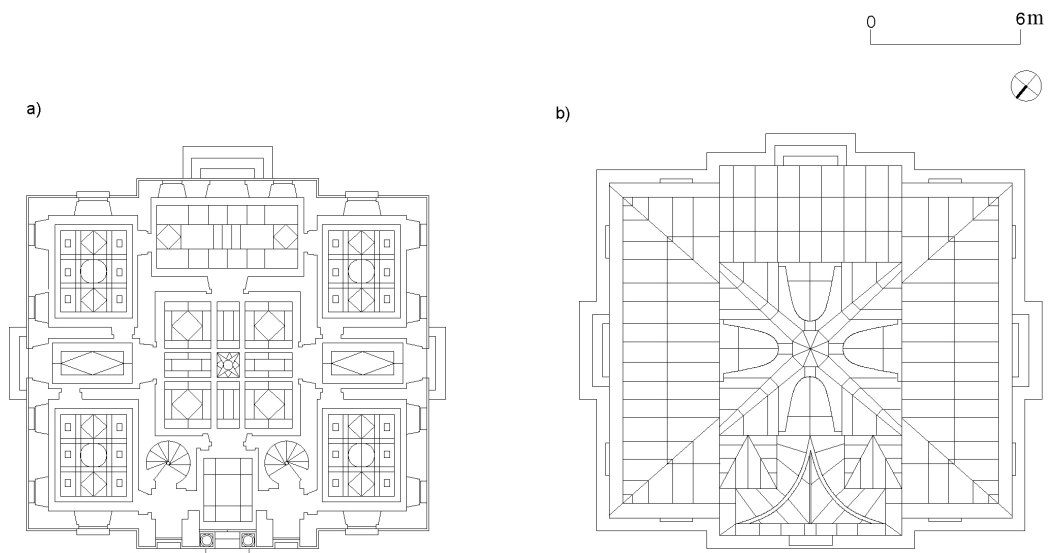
La Casita de Arriba, a) pianta a quota 1.5m e b) pianta delle coperture. Elaborazione grafica degli autori.
